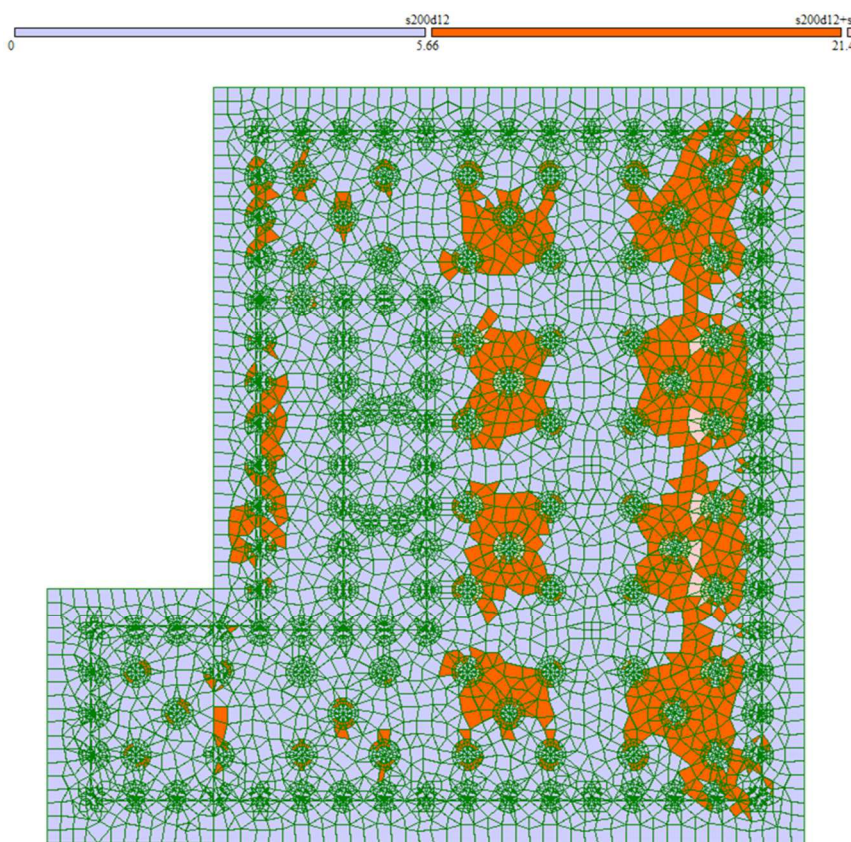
Верхнее армирование фундаментной плиты по направлению y
